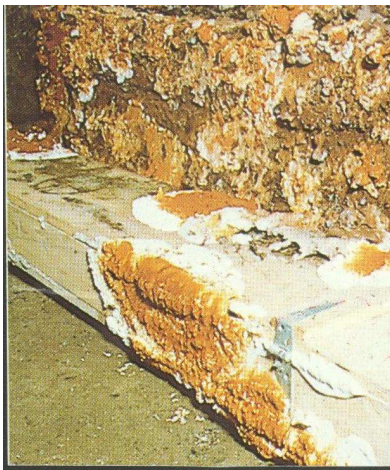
Echter Hausschwamm zerstört Holz und Mauerwerk
